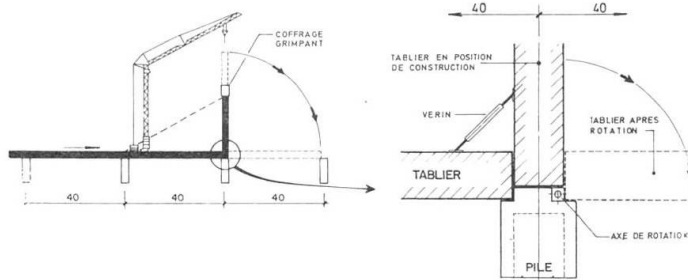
Construction d'un tablier à l'avancement par rotation dans un plan vertical
